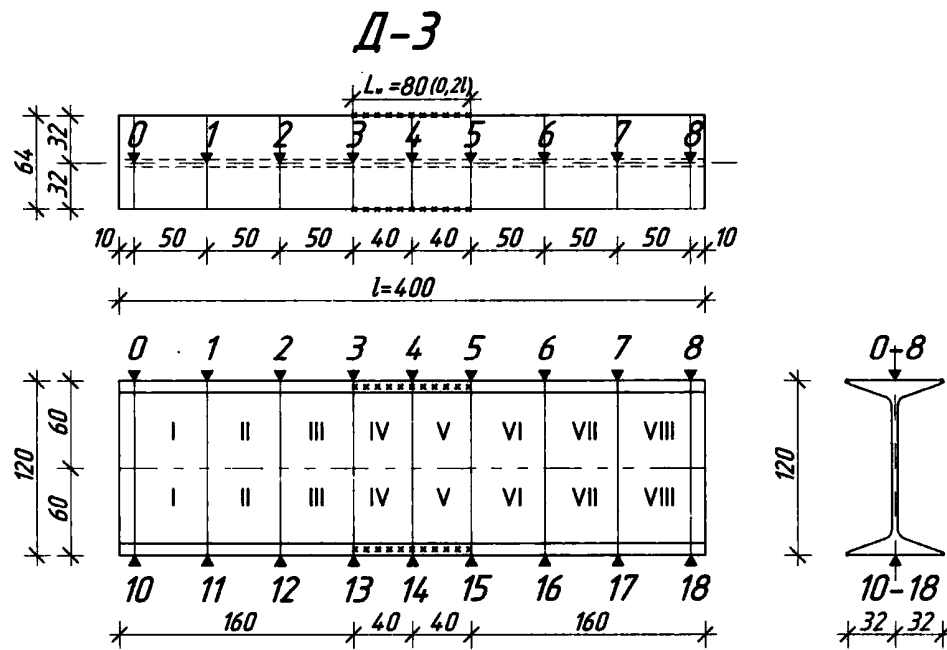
Схема наплавления сварных валиков в образце Д-3
